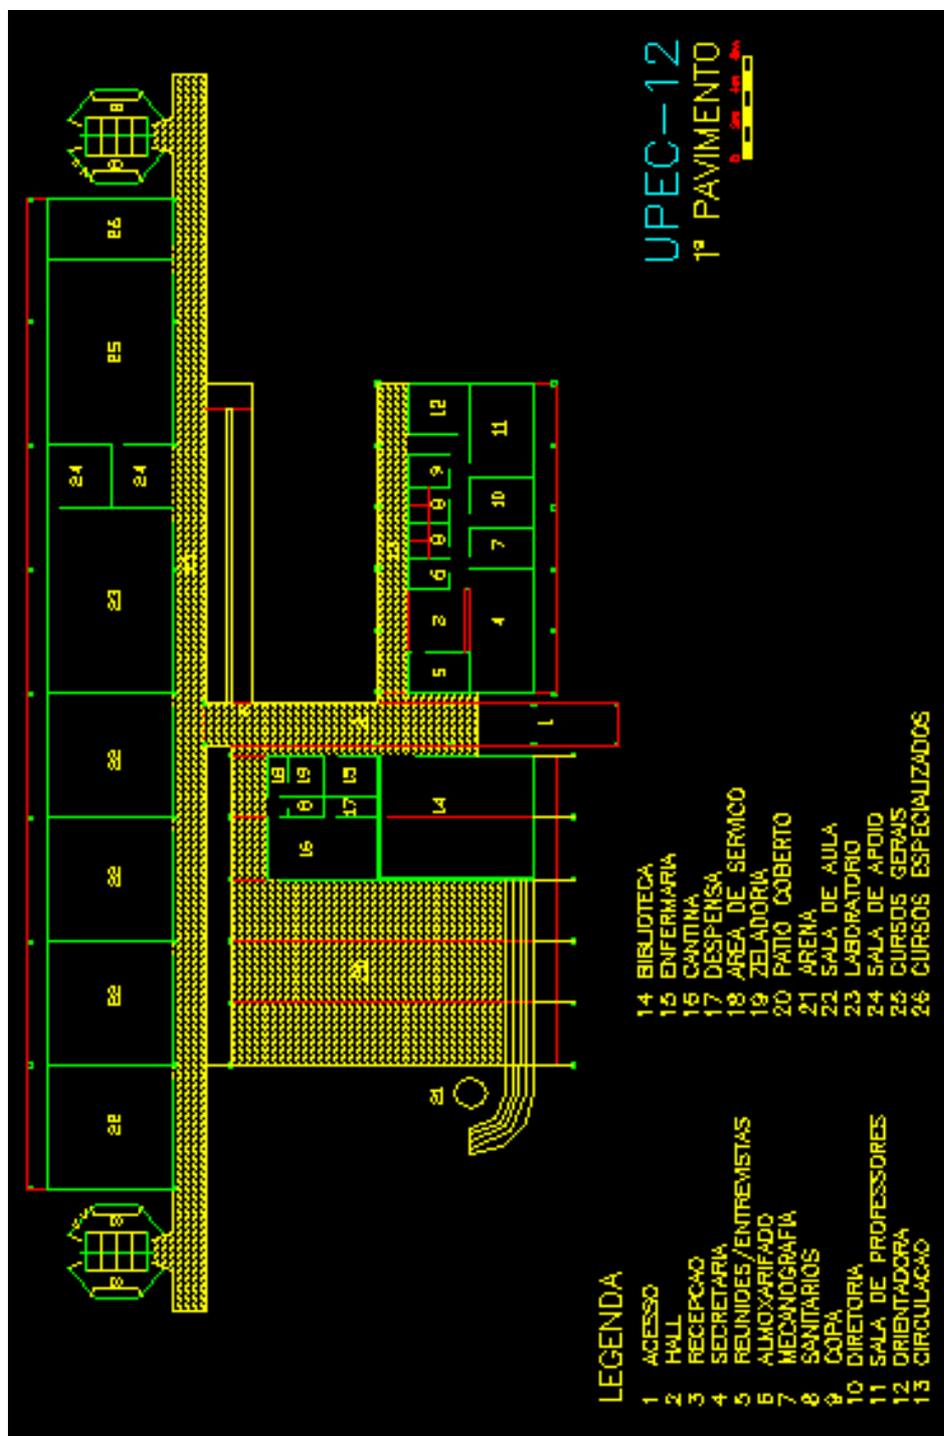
UPEC-12 / PLANTA 1º NÍVEL
